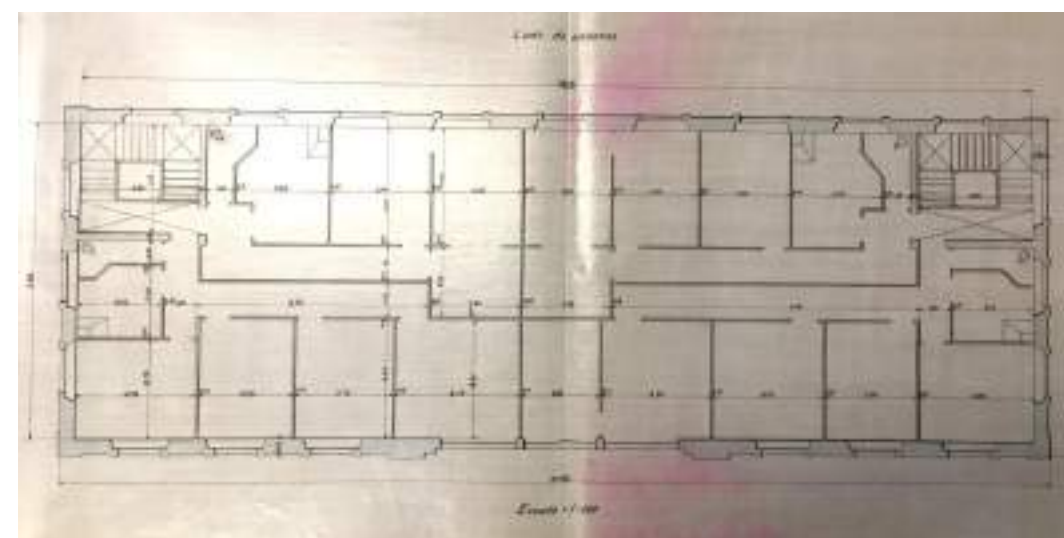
Distribución interna de las viviendas en la segunda planta del pabellón principal de la estación de Cartagena, 1906, en "Plano del Edificio de Viajeros, Planta Principal, 1906". AHF-MFM., signatura B57-6 2/16
